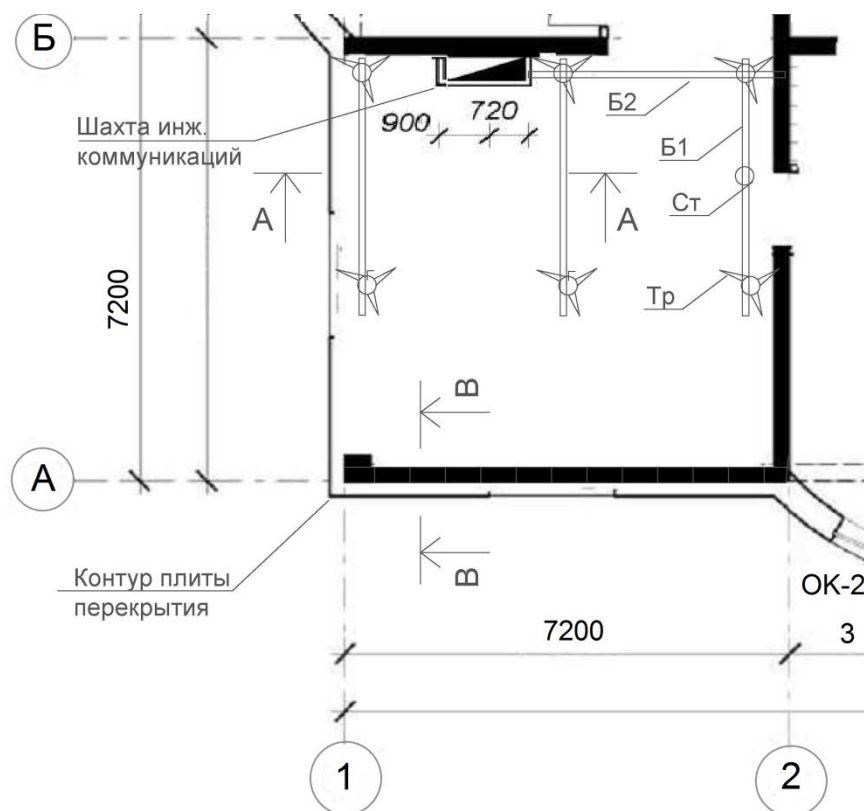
Фрагмент плана этажа, где нужно установить опалубку перекрытия (черной заливкой показаны несущие монолитные железобетонные стены)
